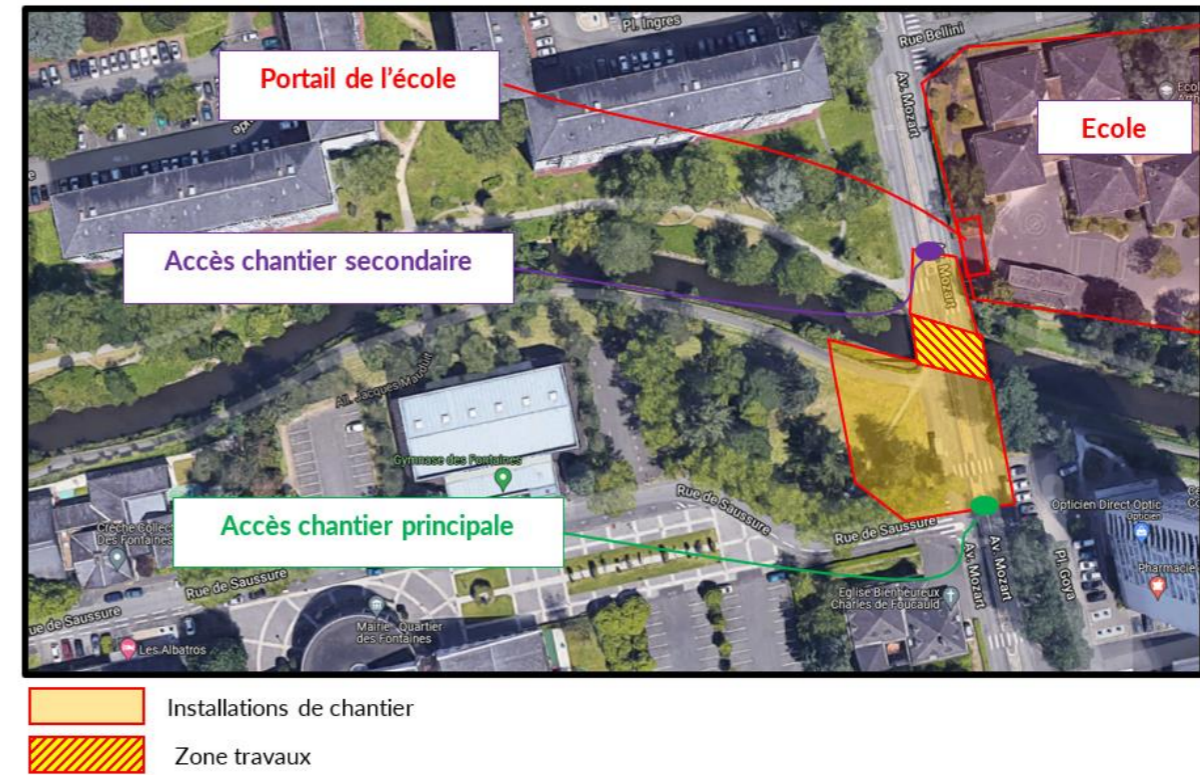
accès emprise chantier au niveau du Pont Mozart
